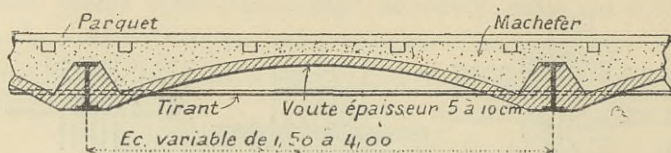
Plancher avec poutrelles en fer et voutains en ciment armé.
